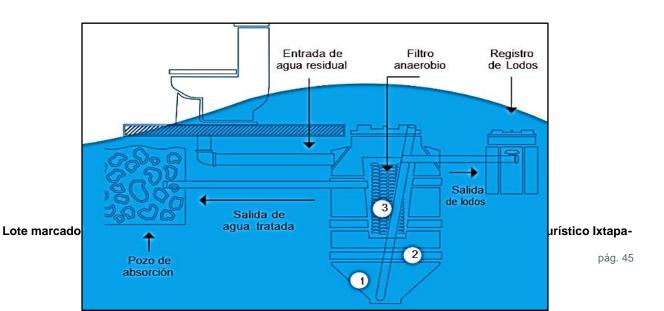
Características de la Planta de Tratamiento.
